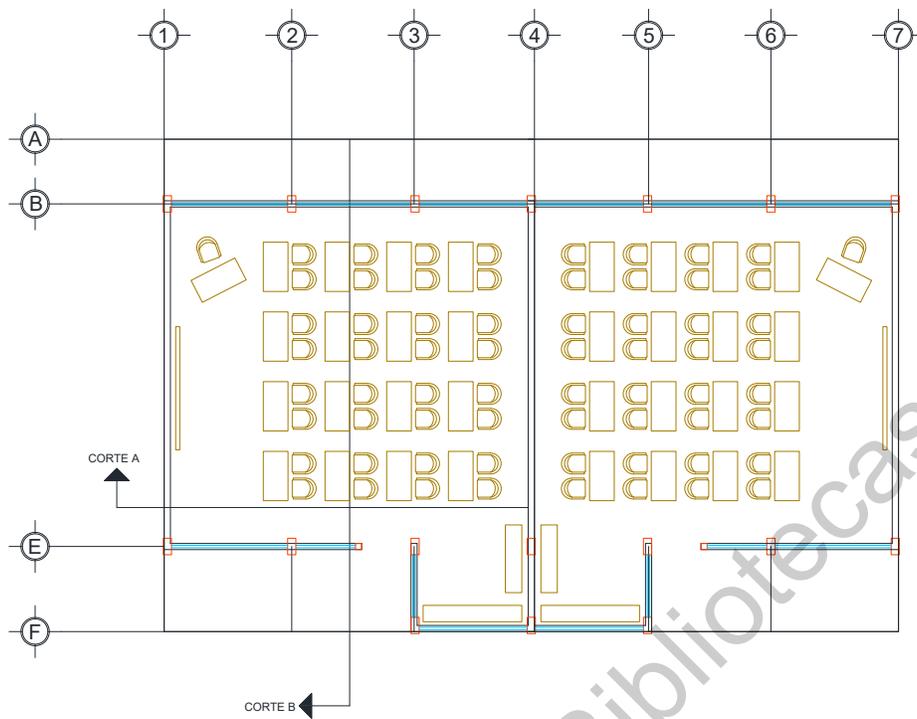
Planta Arquitectónica Zona B (Elaboración Propia)
